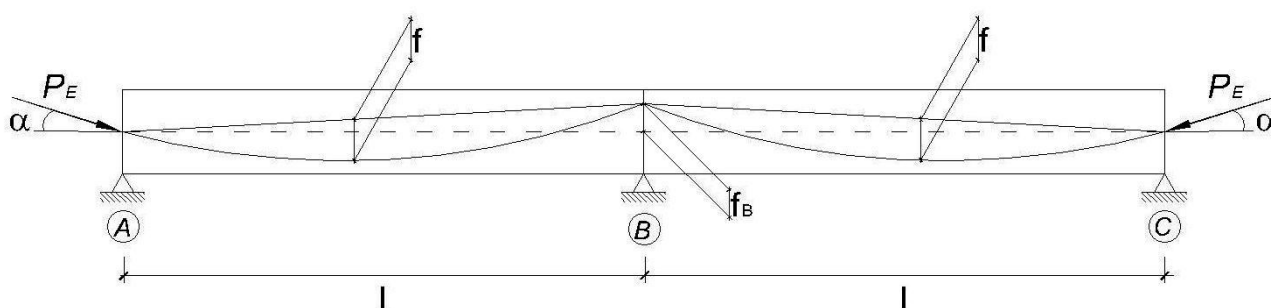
Traçado simplificado do cabo de pré-esforço numa estrutura hiperstática.
